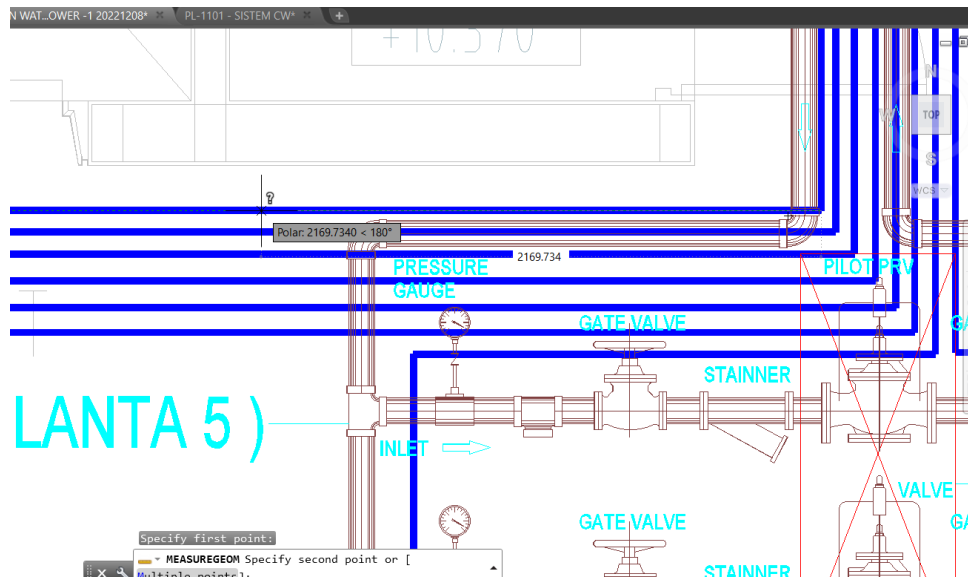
7 Denah Instalasi Air Bersih Lantai unit
